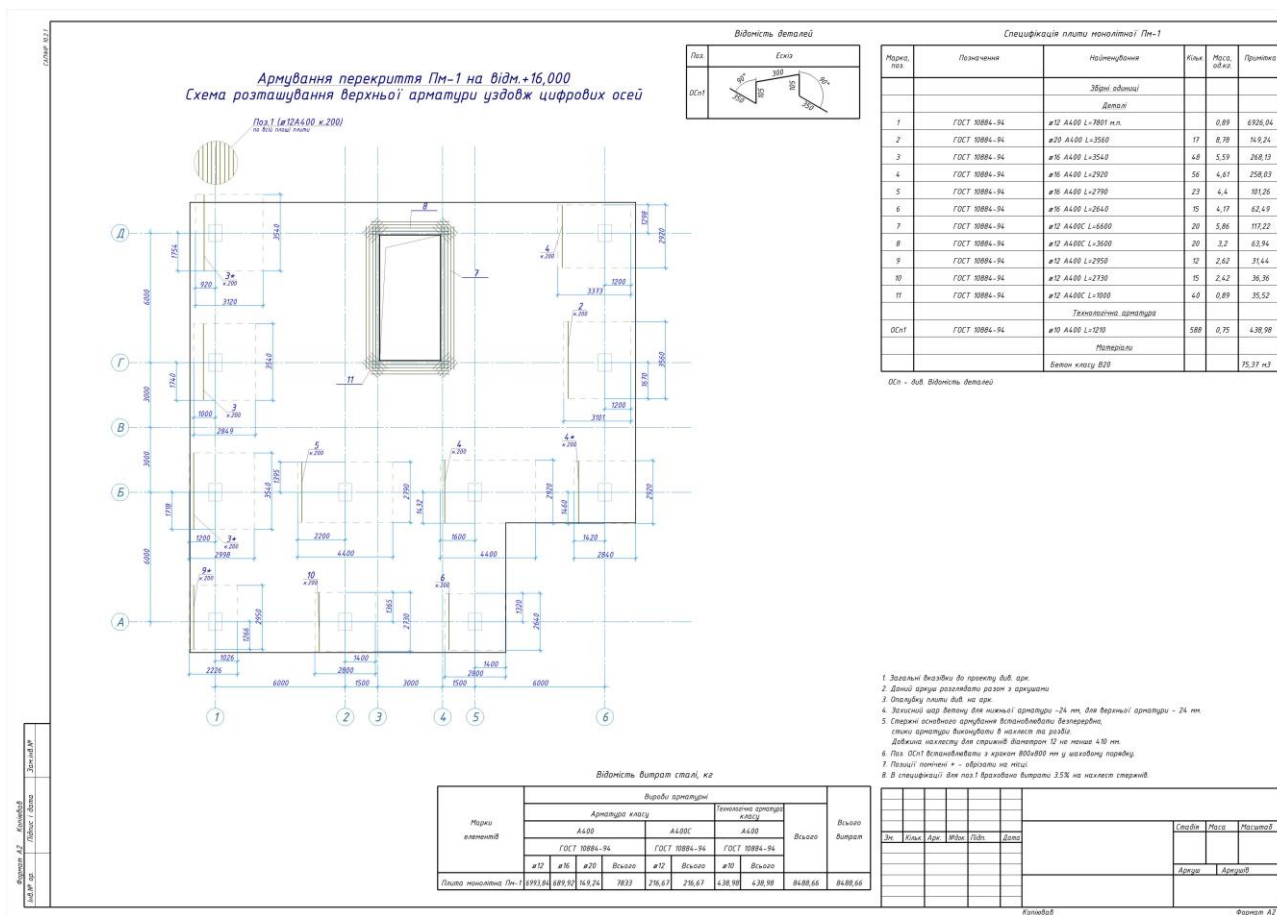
Креслення розташування арматури в плиті перекриття на відмітці +16.000
